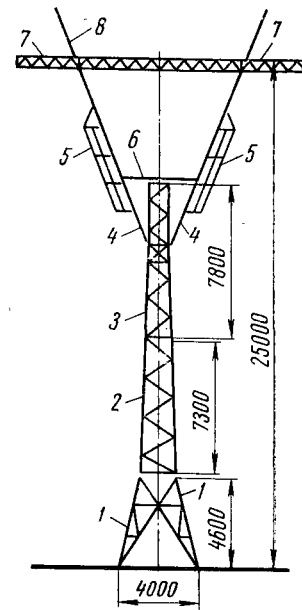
Схема конструкции опоры линии электропередачи:
